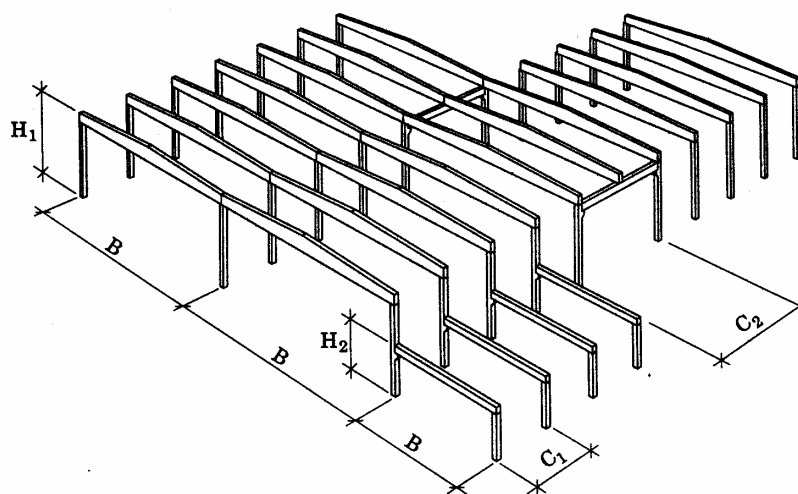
Diretrizes para vãos em traves planas (dimensões em m)
